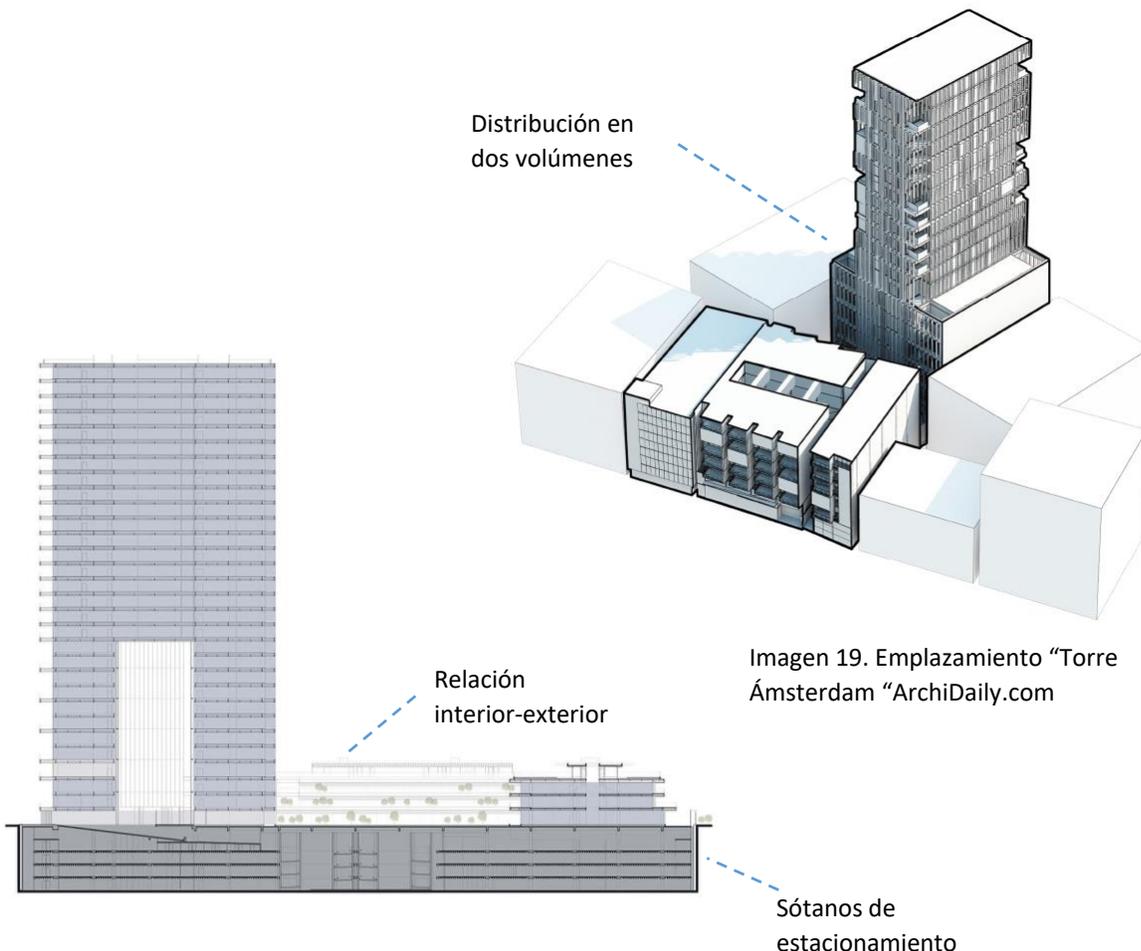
Emplazamiento “Torre Amsterdam” ArchiDaily.com
